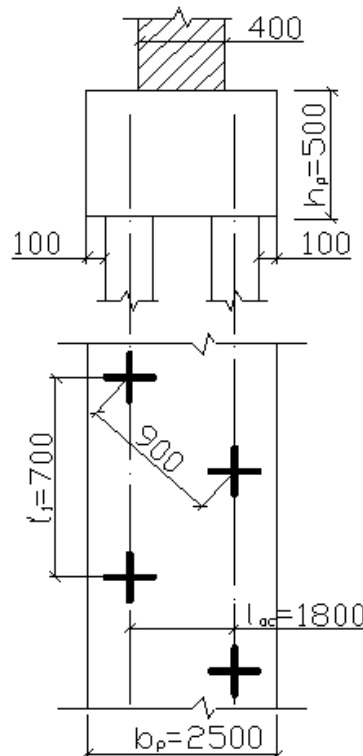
До розрахунку буронабивного фундаменту в 3 – му перерізі
